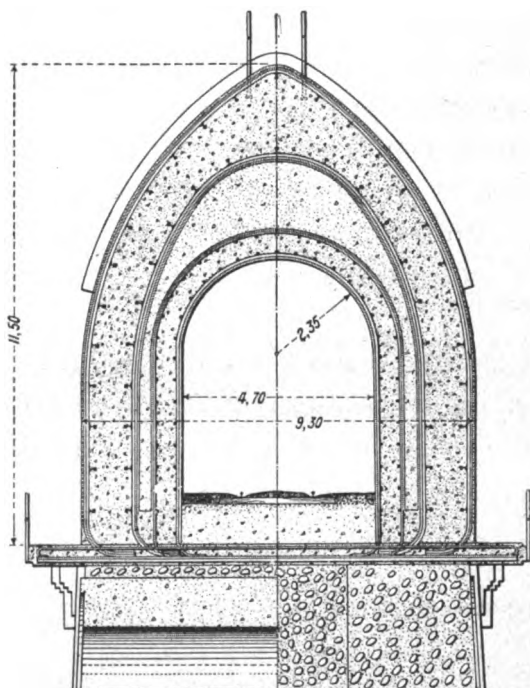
Sezione trasversale della parte coperta del ponte.
